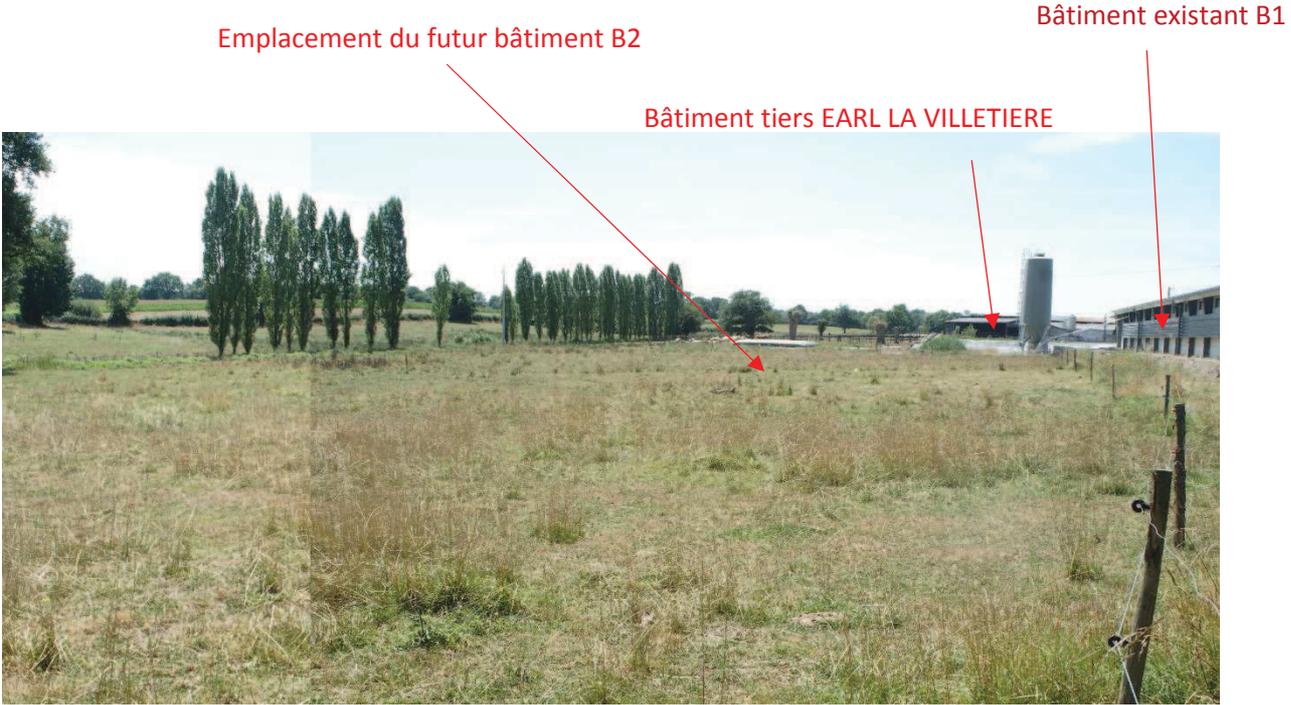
Vue du Sud-Ouest sur le futur bâtiment B2
